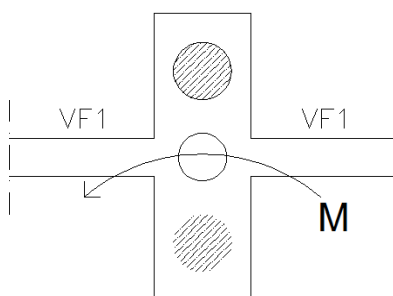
Momento a absorver pelas Vigas de Fundação
